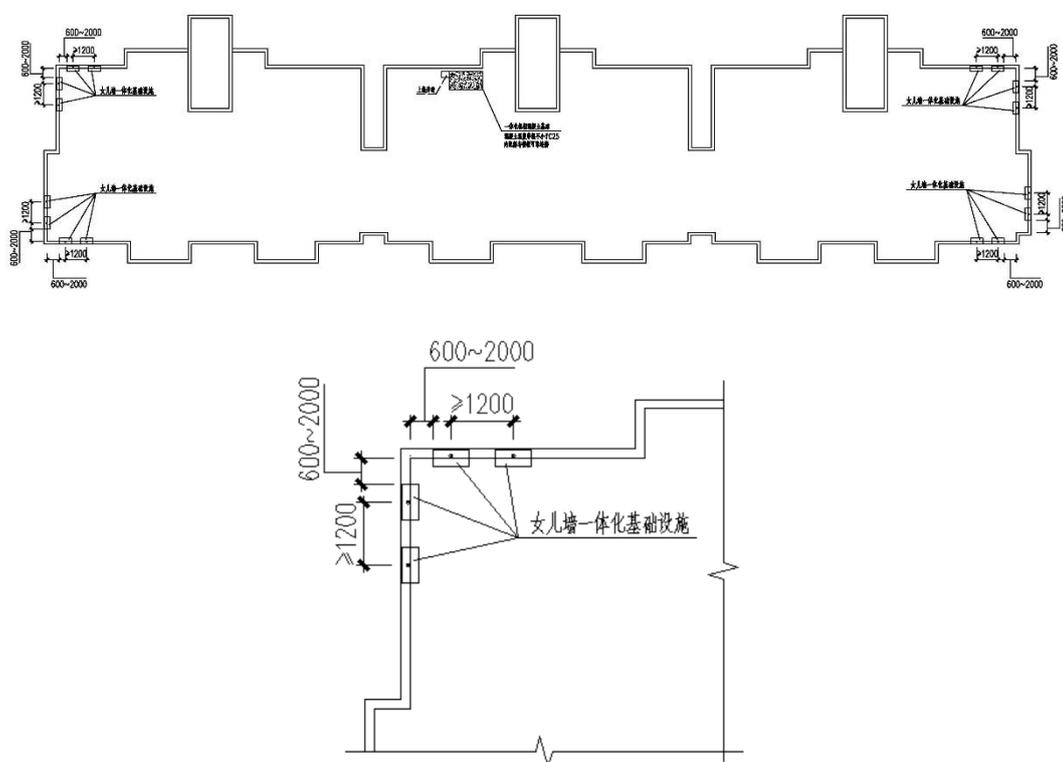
平屋面屋面设施（女儿墙一体化建设方式）平面布置图
